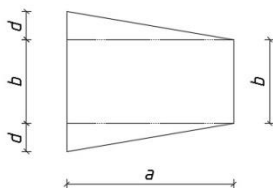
К определению оптимальной площади трапецеидального фундамента
